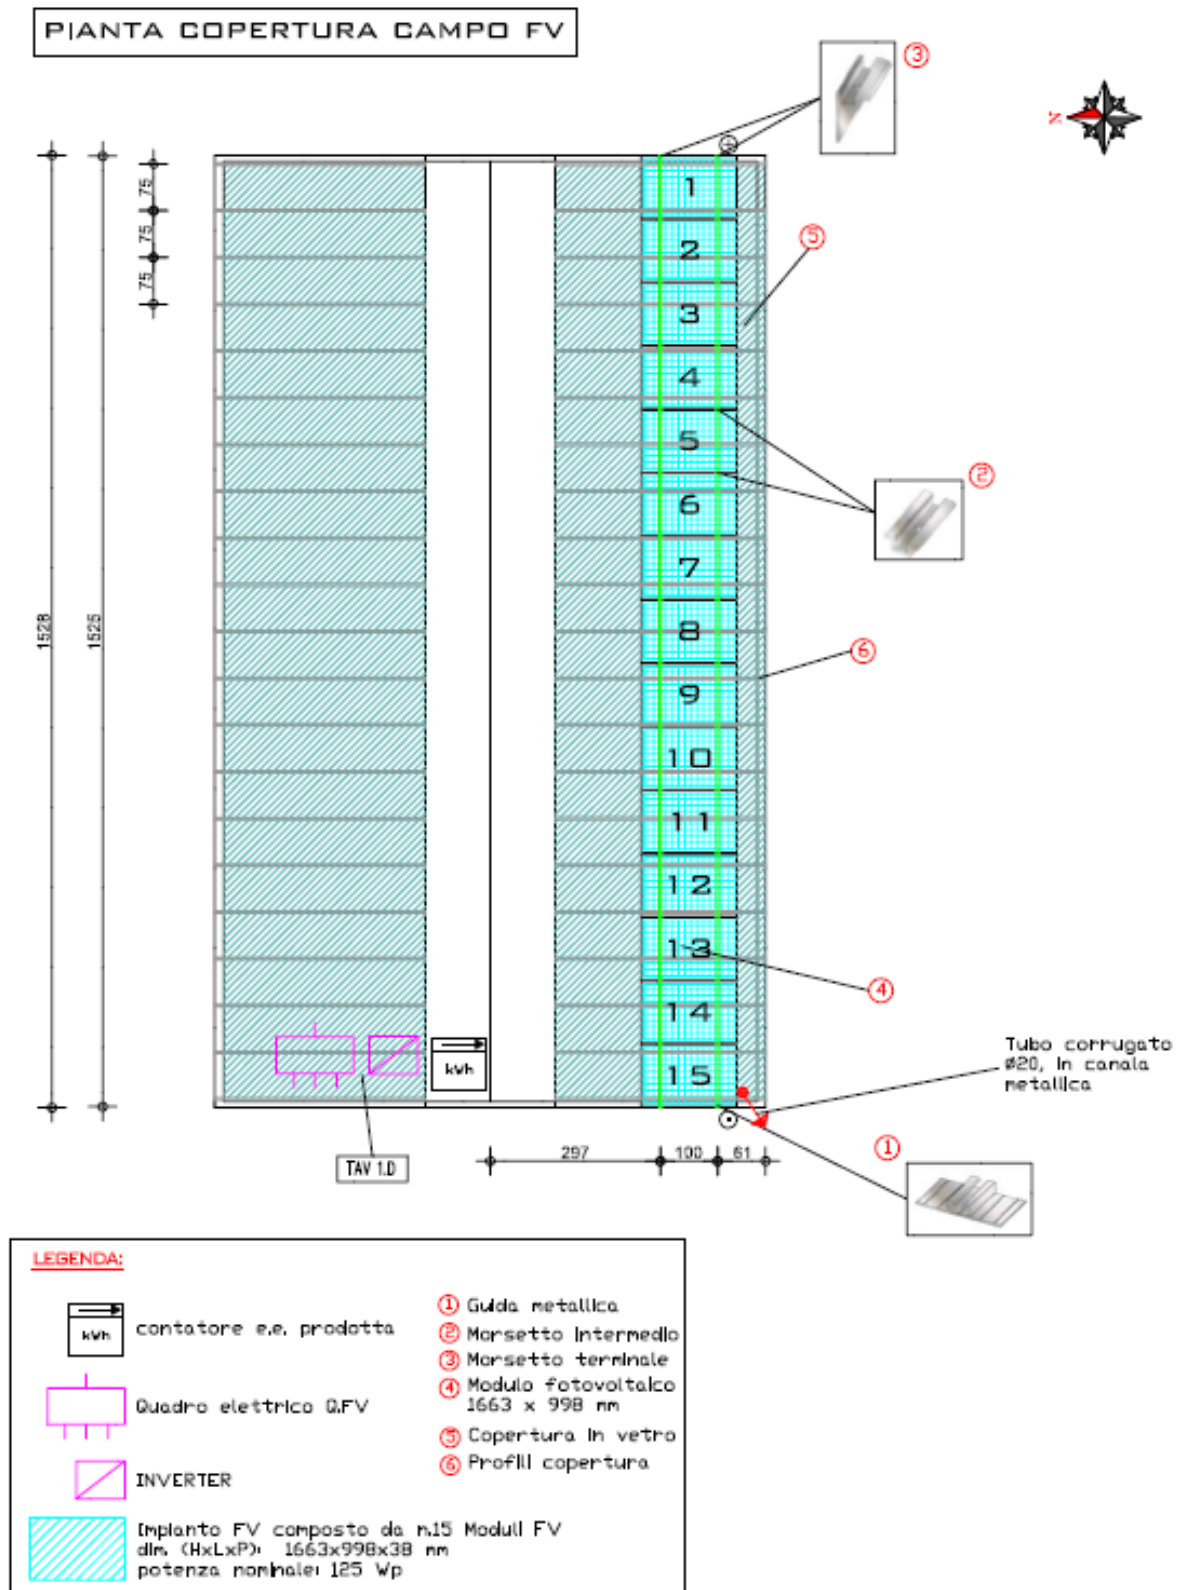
Impianto fotovoltaico – Tavola di progetto – Pianta
